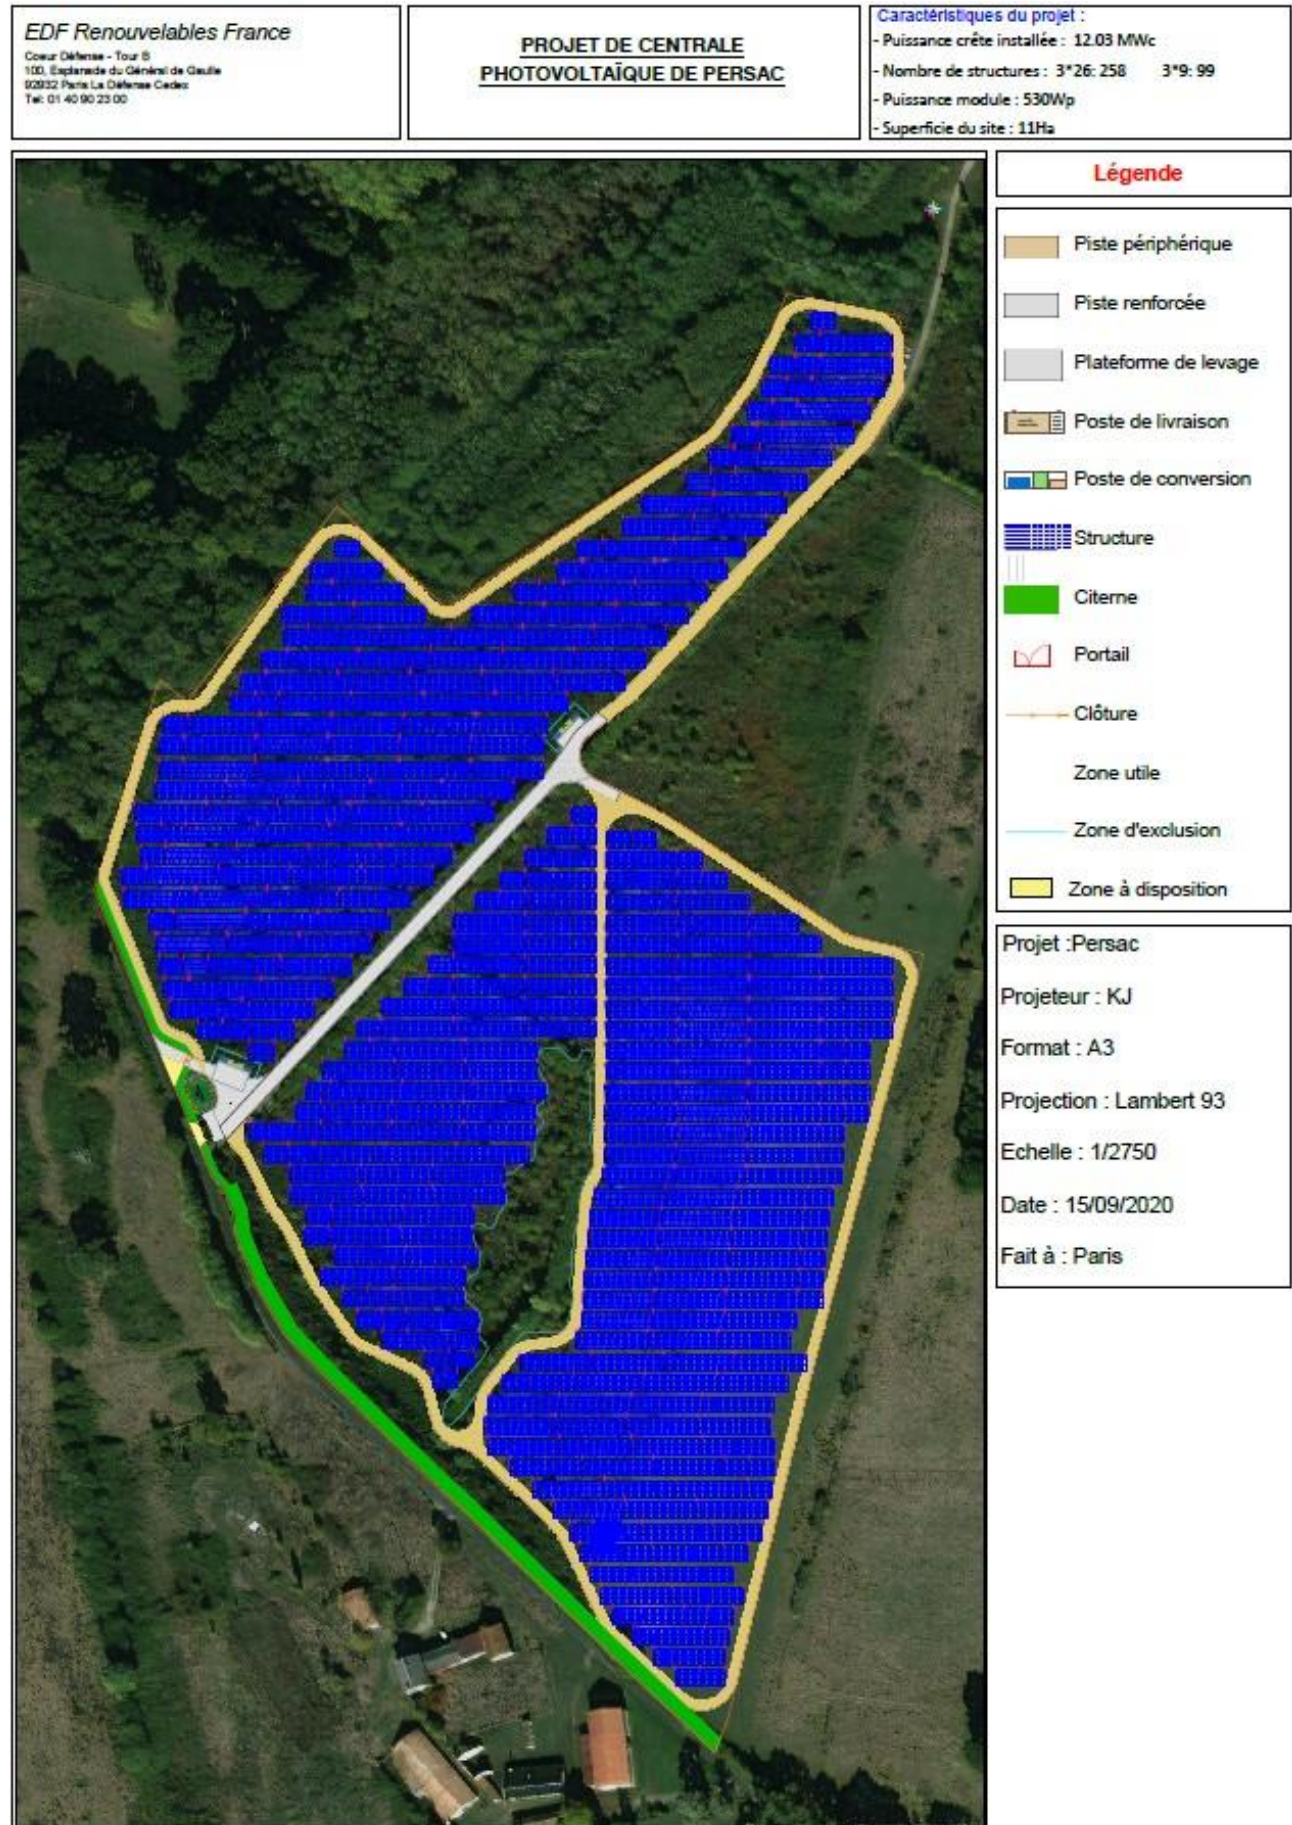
Plan de masse de la centrale photovoltaïque de Persac
